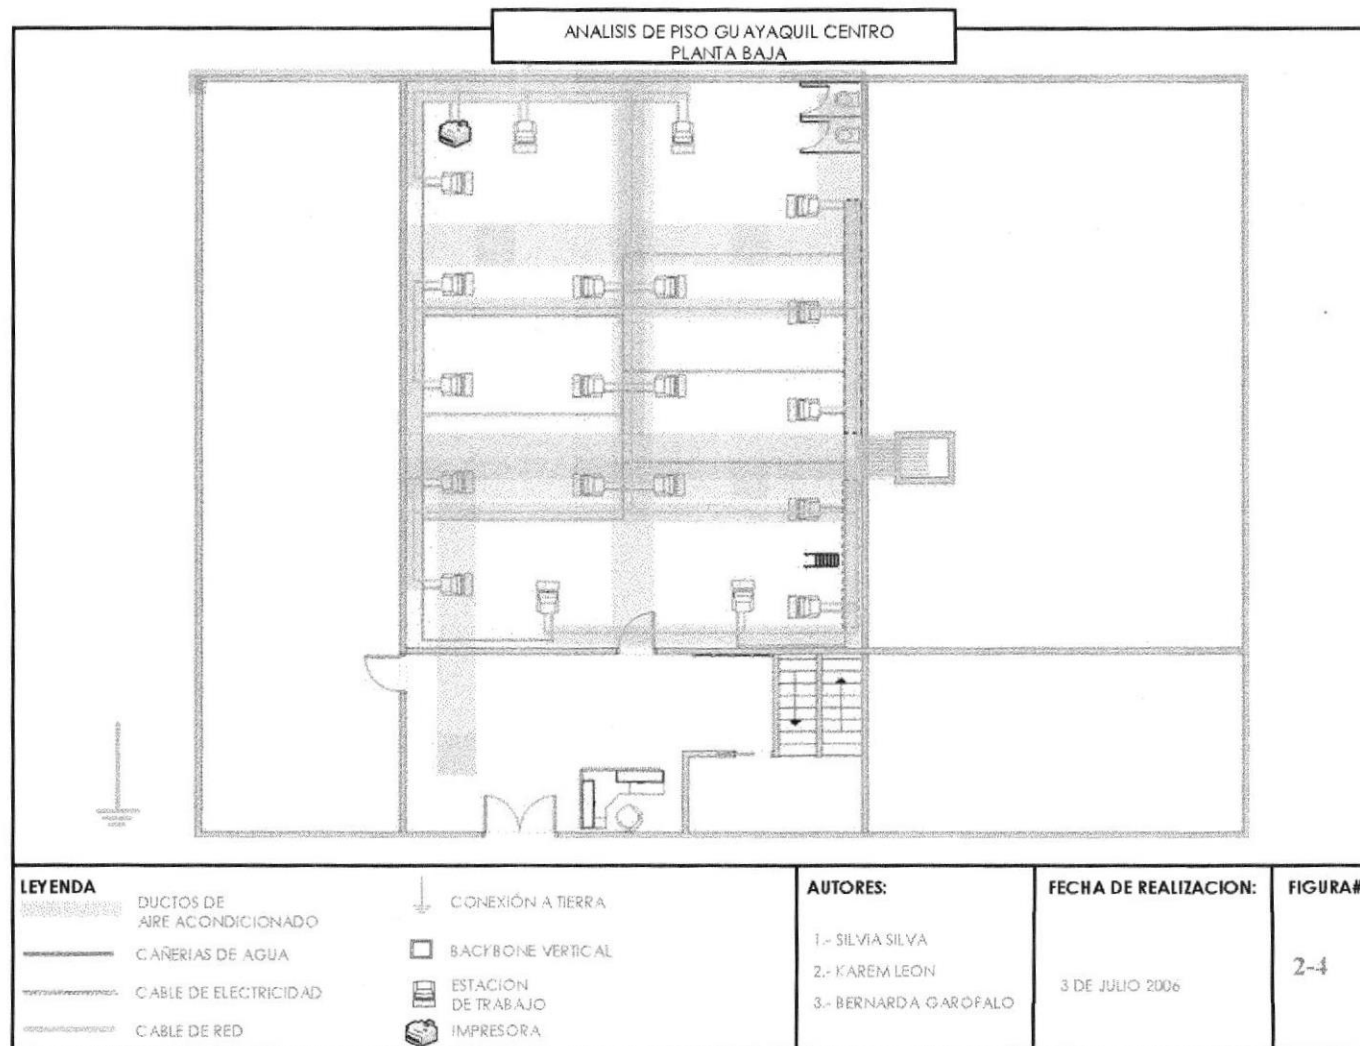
Situación Actual de Planta Baja-Edificio Matriz
